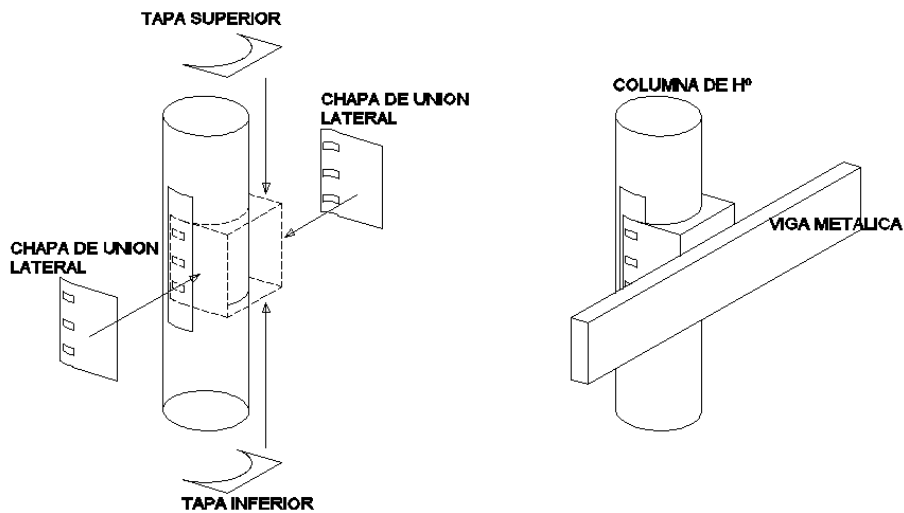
"Perspectiva explotada de los elementos de unión VM-inserto"
